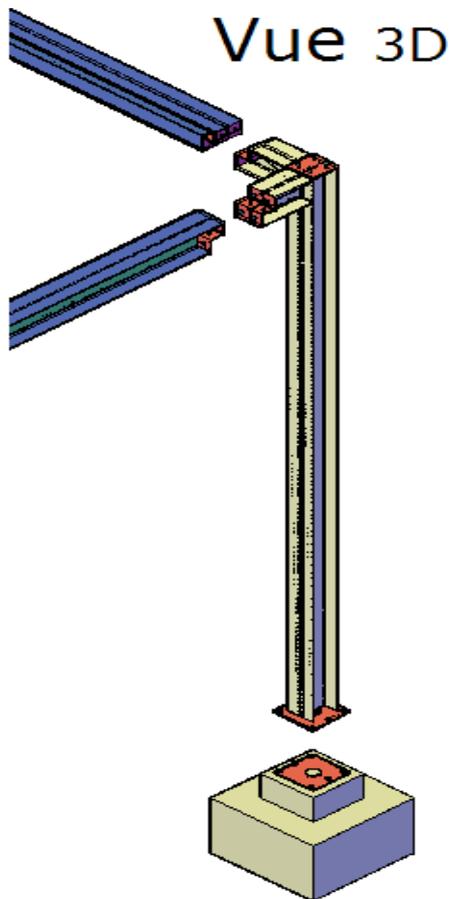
Detail assemblage poteau d'angle avec poutre et semelle
